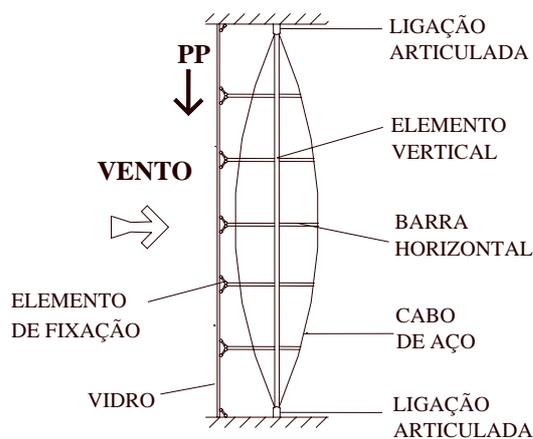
Corte mostrando o esquema de fixação do painel de vidro com arco atirantado.
